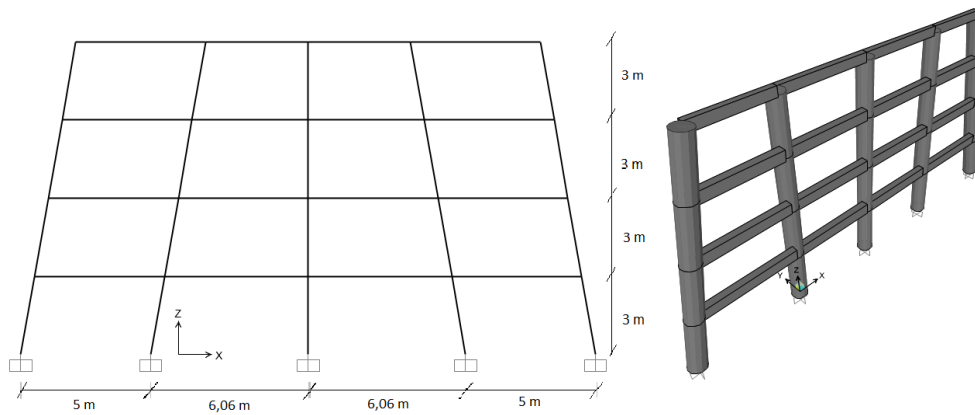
Pórtico Modelo B – 10g, inclinación de columnas 10° respecto al eje vertical.
